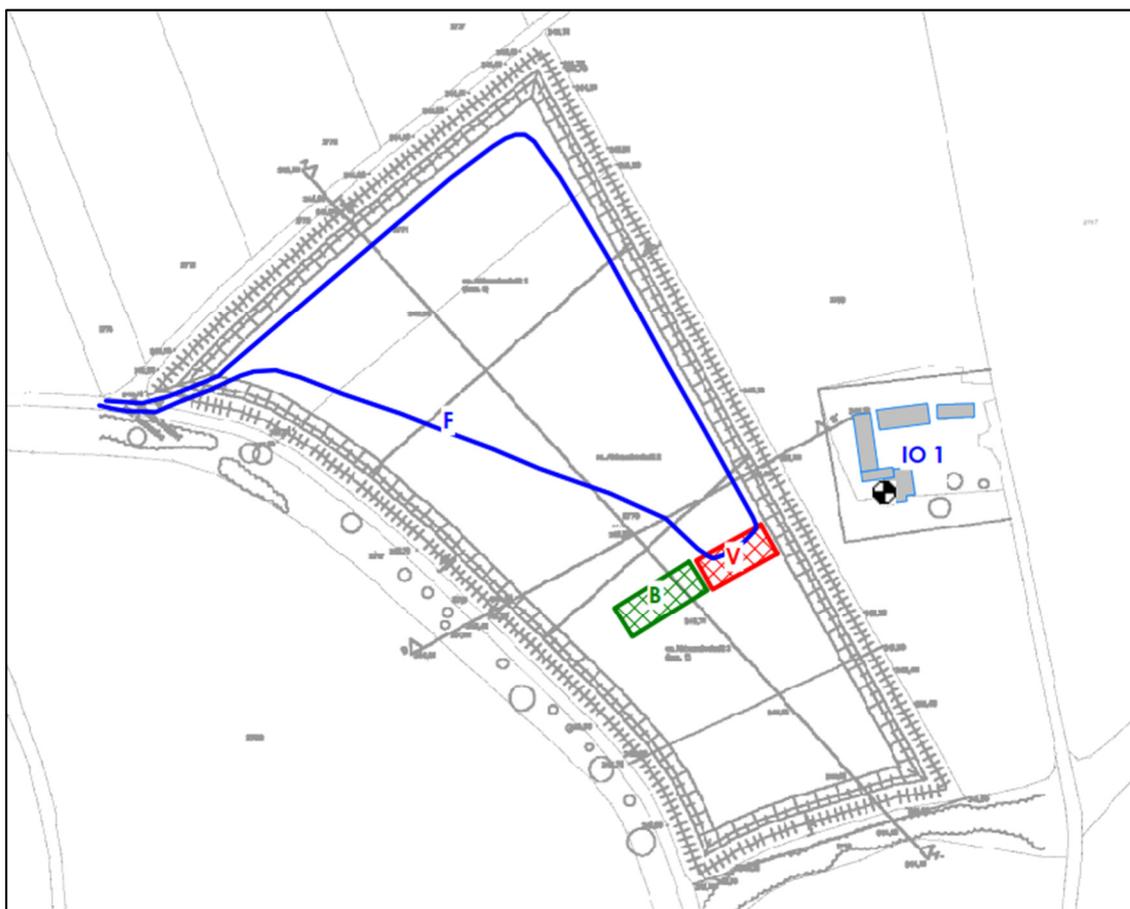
Lageplan mit Darstellung der relevanten Schallquellen
